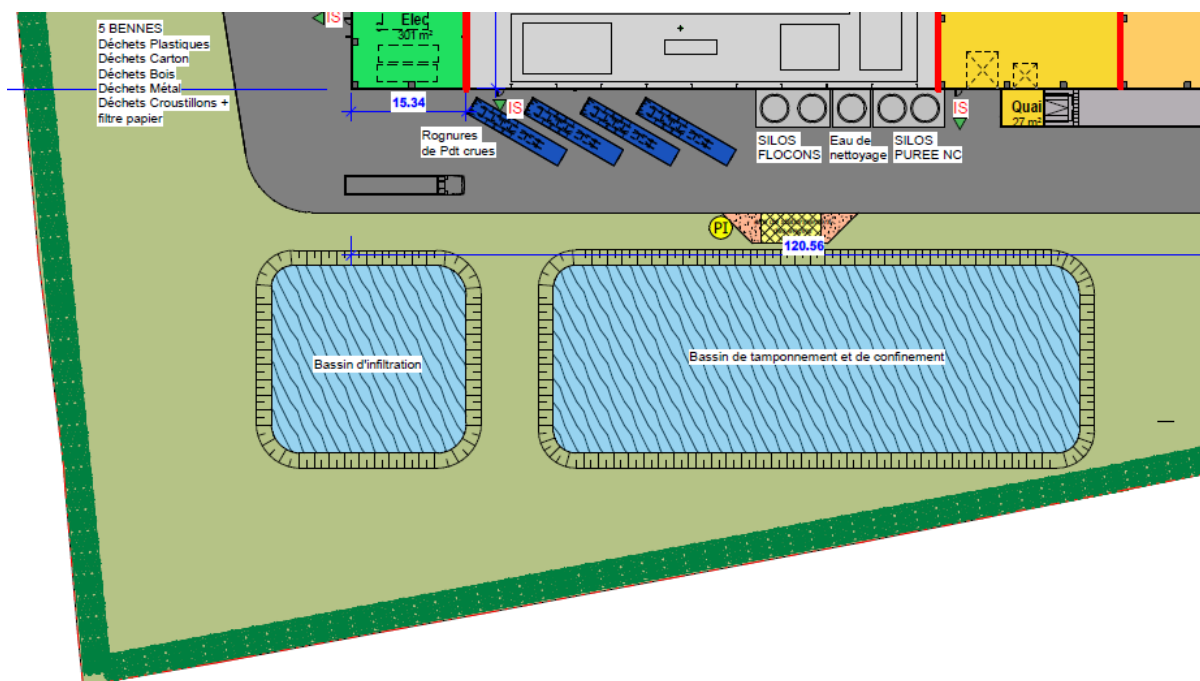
Zoom sur les ouvrages de tamponnement des eaux pluviales - Bassin versant Sud
